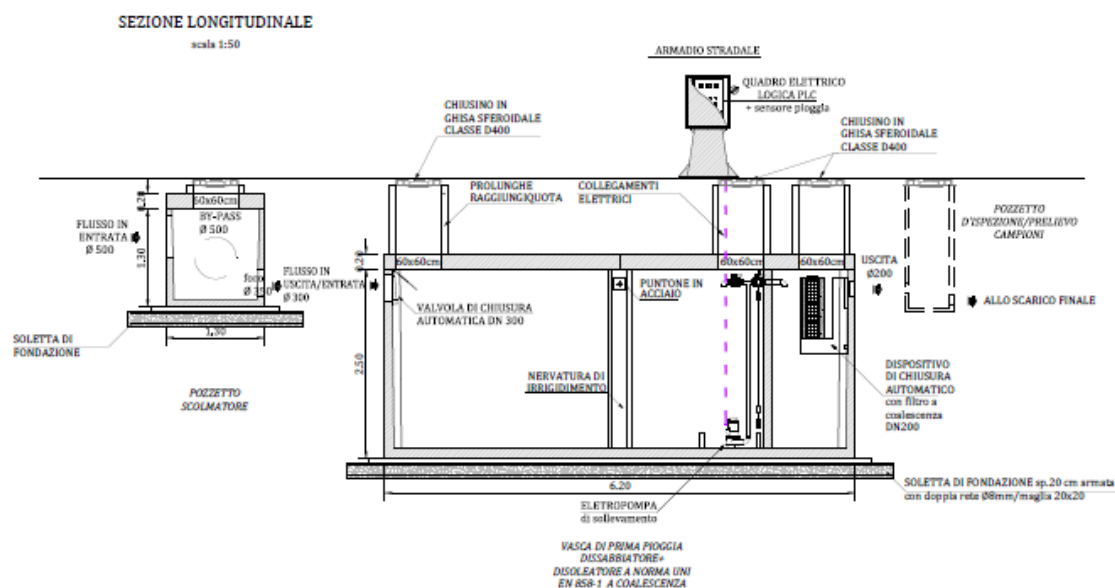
Sezione longitudinale tipo sistema di accumulo e trattamento acque di prima pioggia.
